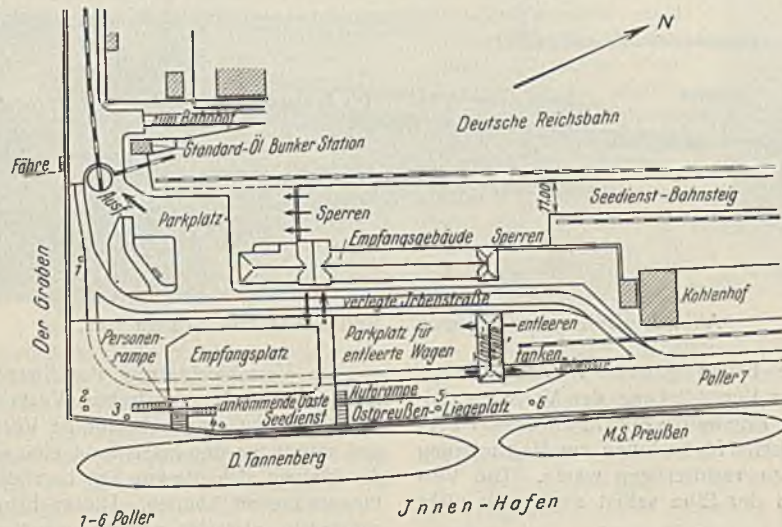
Seediensstbahnstahnhof Pillau, Lageplan.
